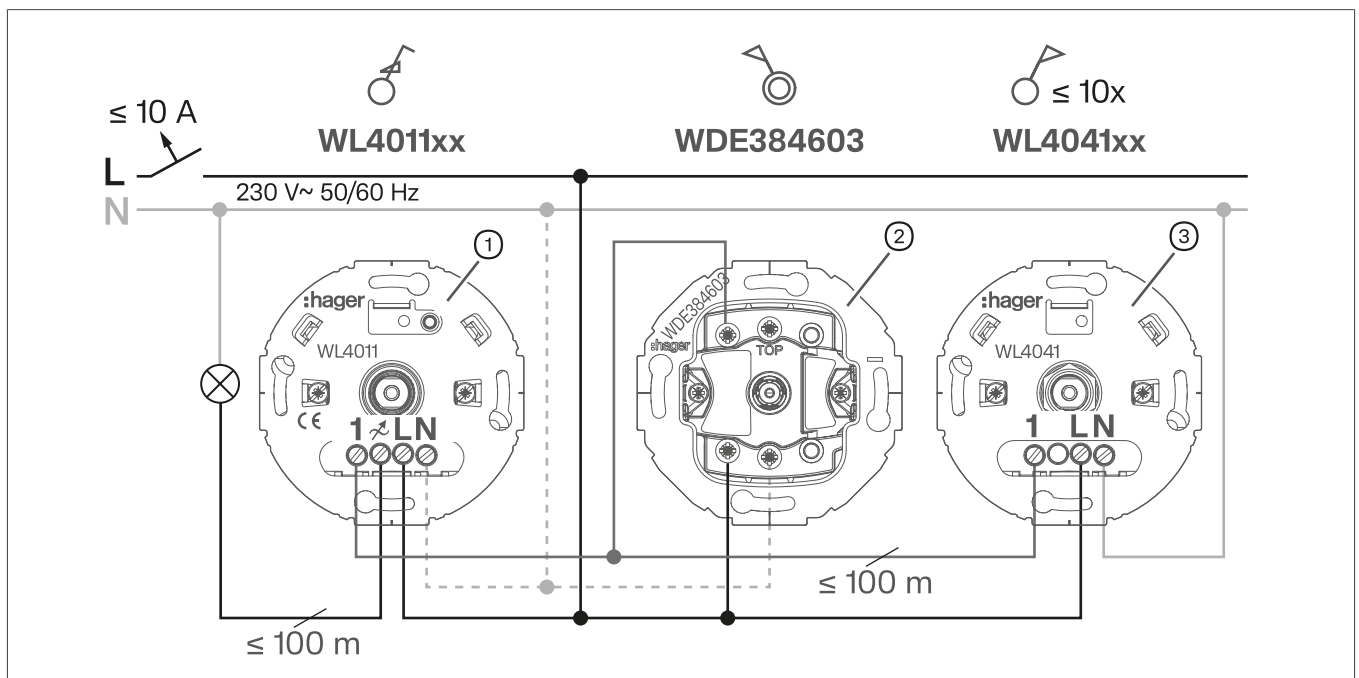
Anschlussplan Universal-Drehdimmer mit Nebenstellen
